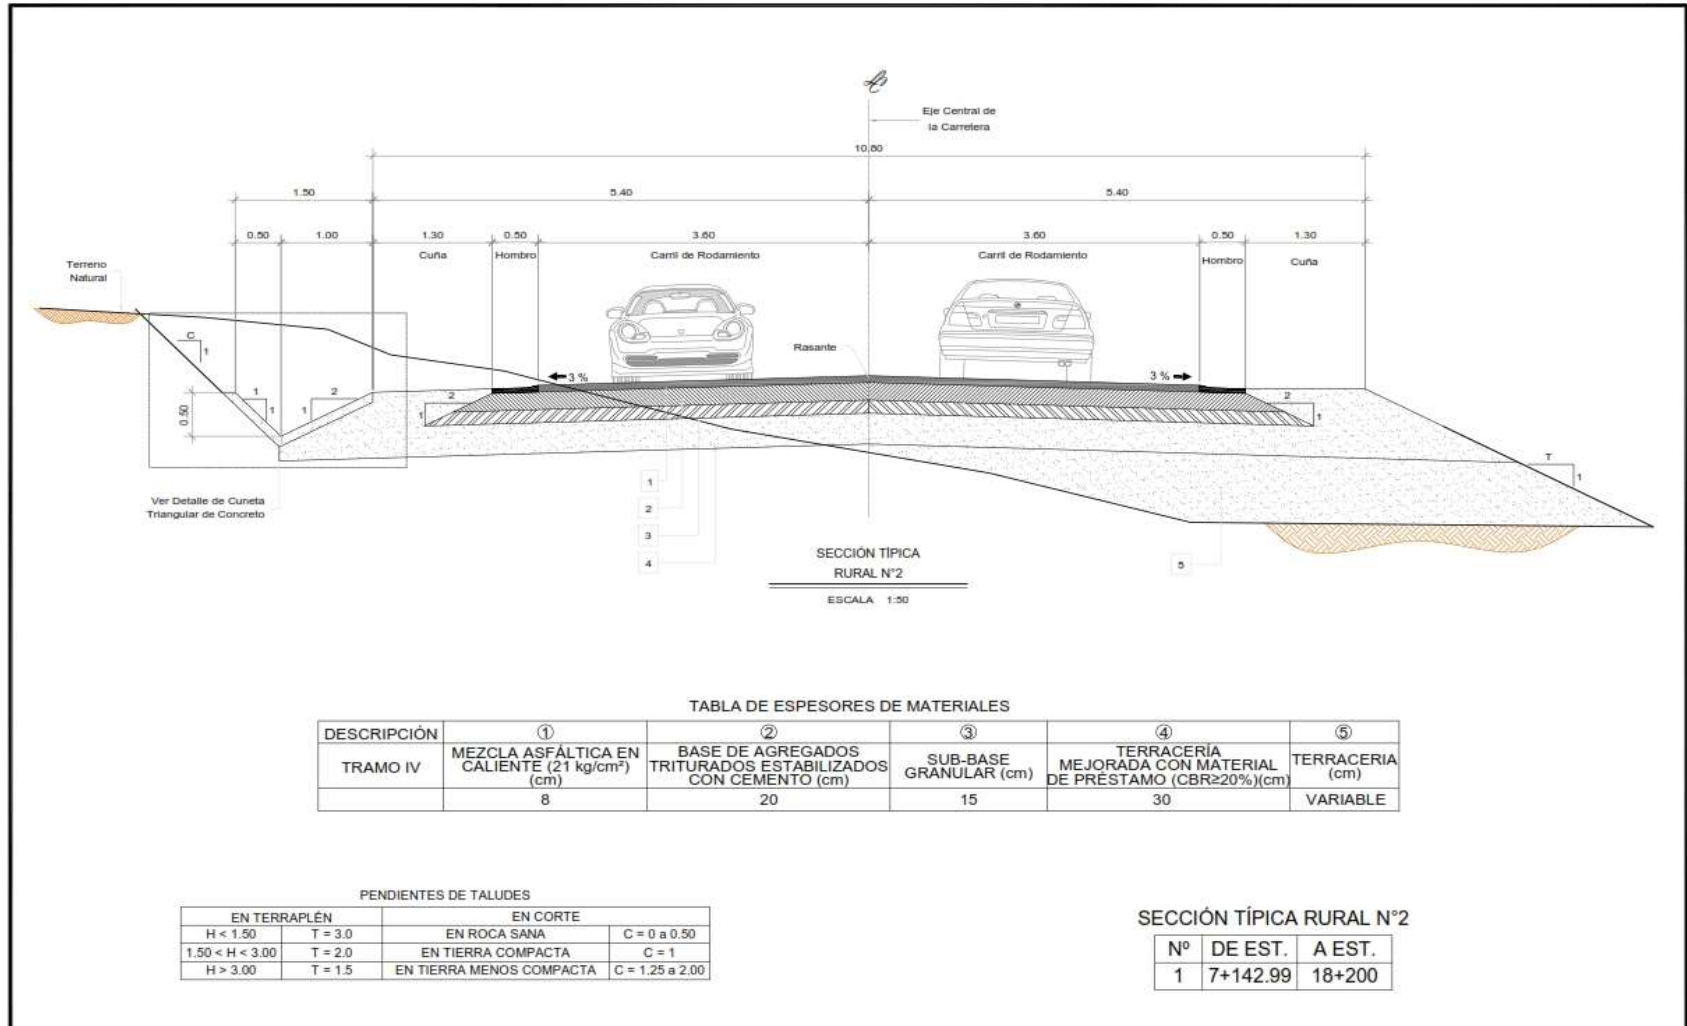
Propuesta de Sección Típica Transversal Zona Rural N°2
